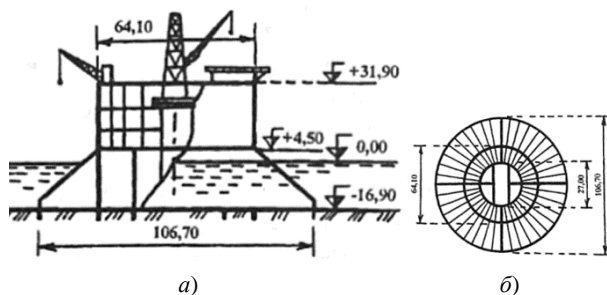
Платформа стальной конструкции для глубин 14–20 м: а) схема; б) вид сверху на опорное основание [2]
